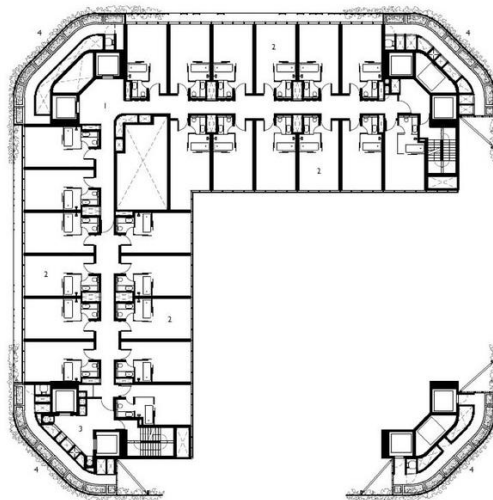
Denah Lantai 21 Oasia Hotel, Singapura
